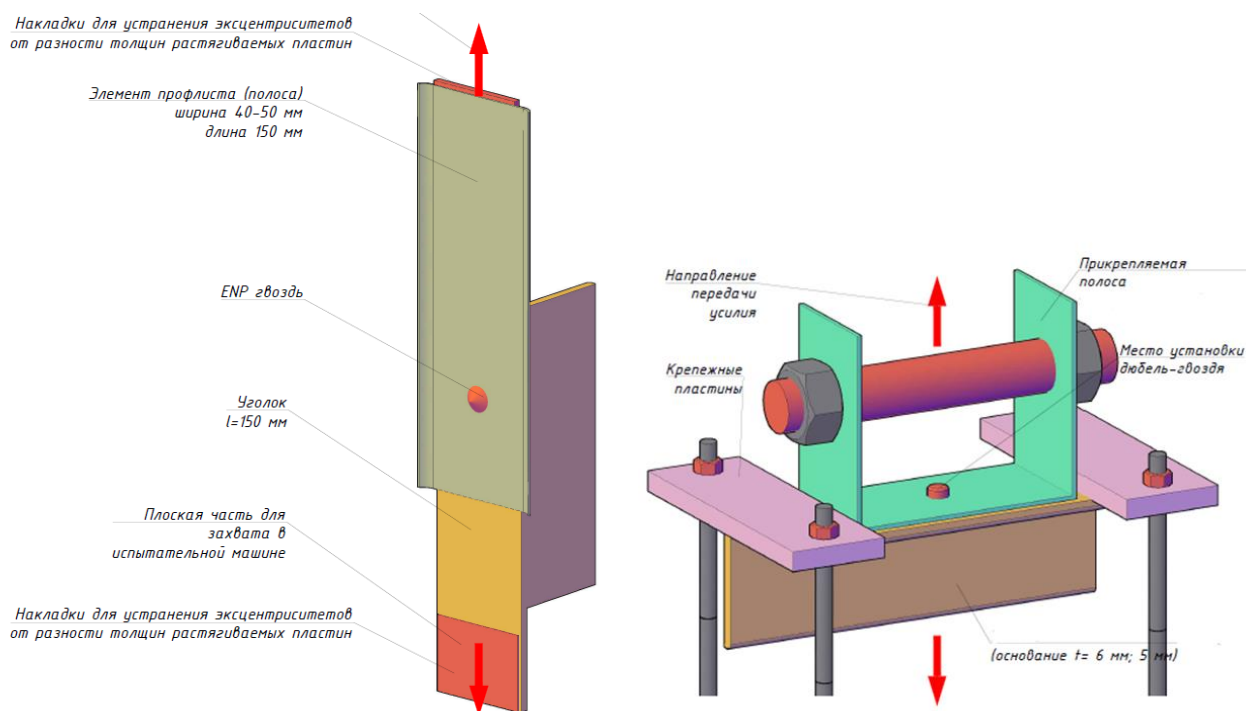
Принципиальная схема испытания дюбель-гвоздя на сдвиг
